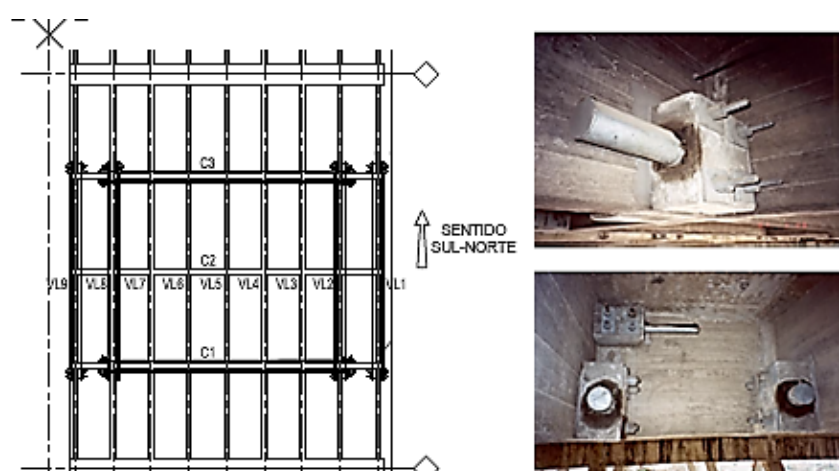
Sistema de pré-esforço exterior nas vigas longitudinais exteriores e carlingas (Brisa, 2002a).
